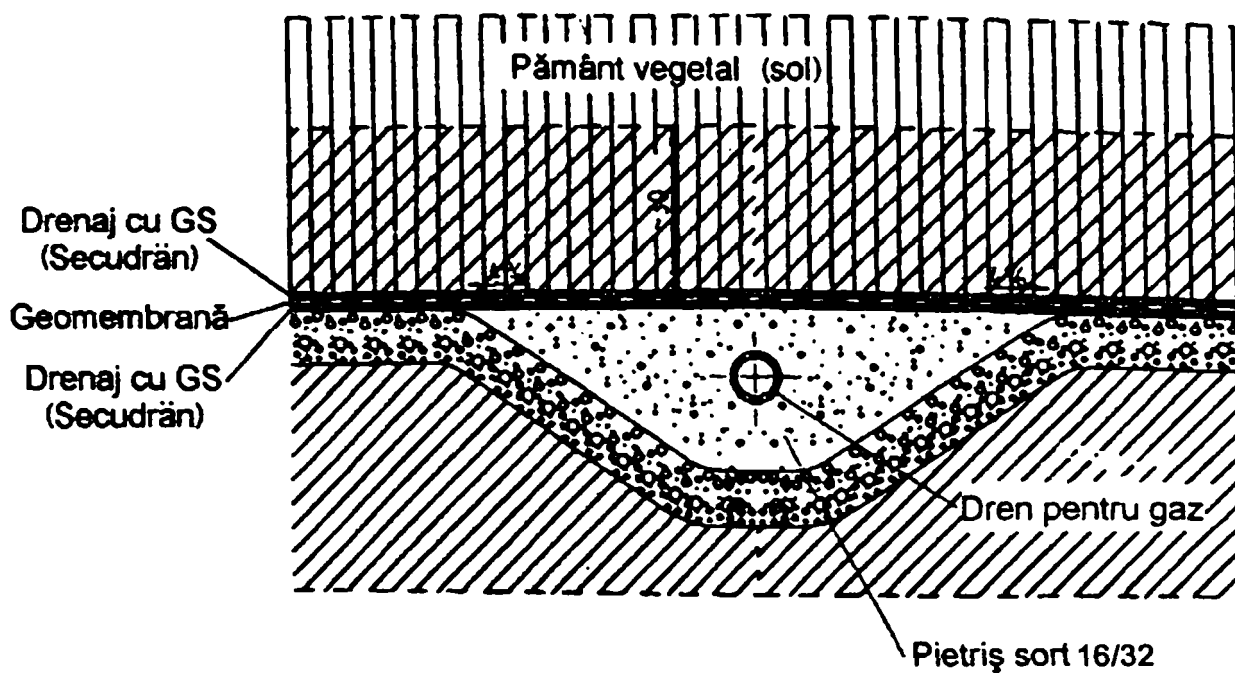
Detaliu de realizare a rețelei de drenaj orizontal pentru captarea biogazului.
